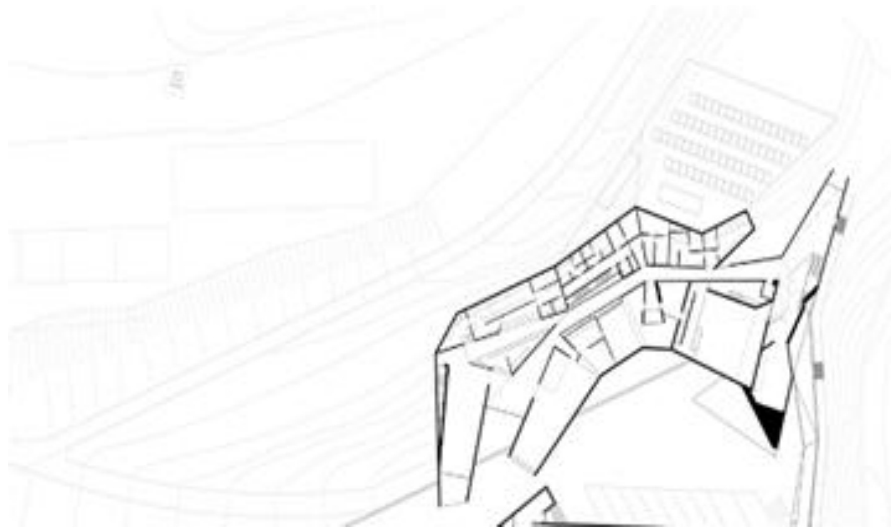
Vista en planta treceavo nivel Centro Remo Do Pocinho
